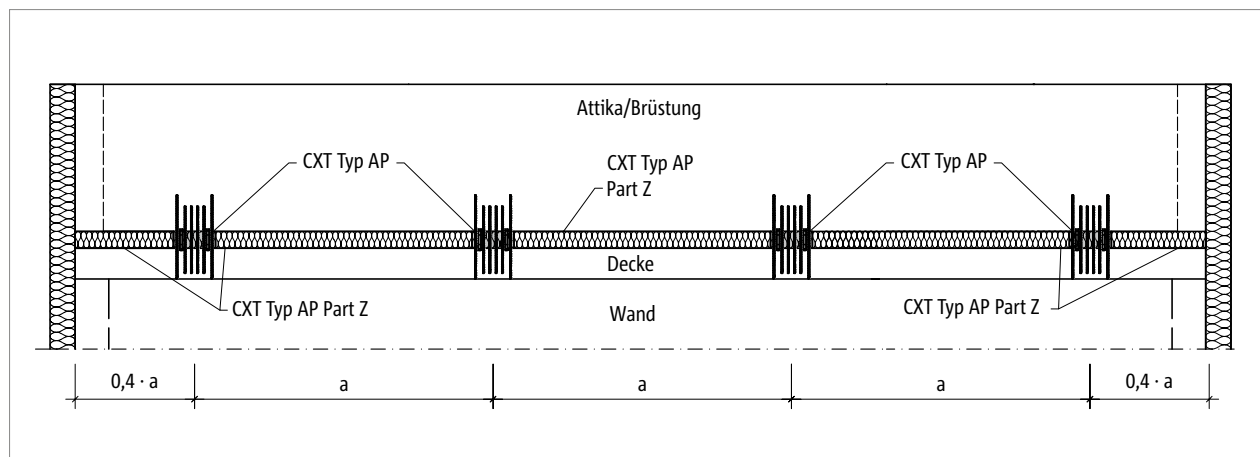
Schöck Isokorb® CXT Typ AP: Anordnung bei Achsabstände $\geq 3 \text{ m}$
